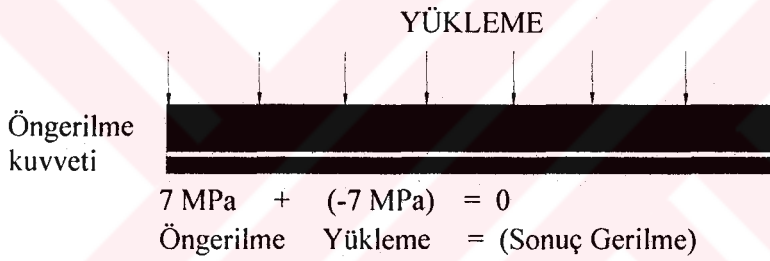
Öngerilmeli beton kiriş üretim yöntemi (14)
